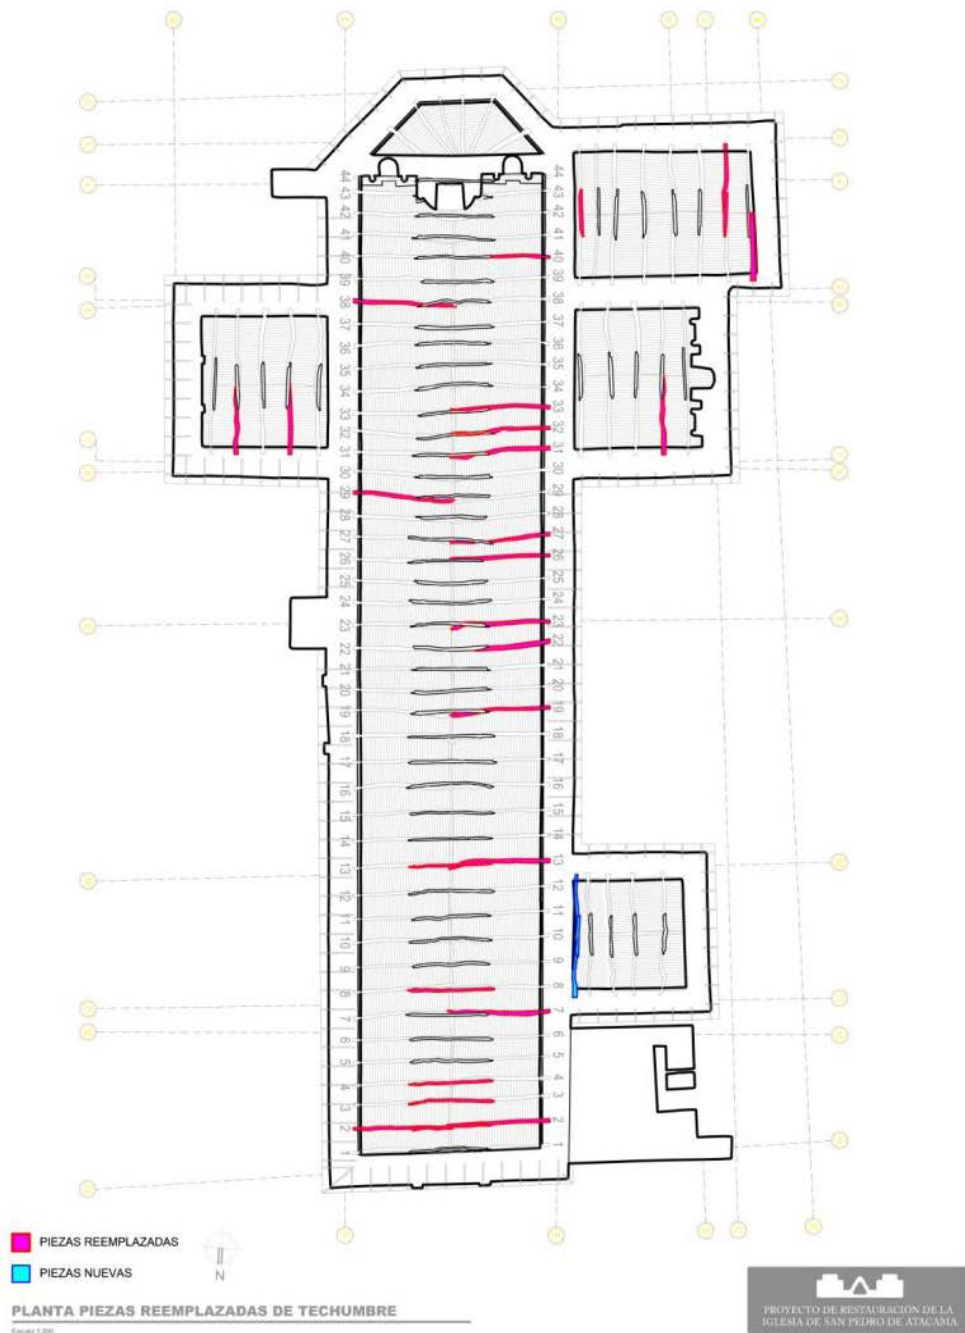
Planta de pares y nudillos reemplazados y piezas nuevas
